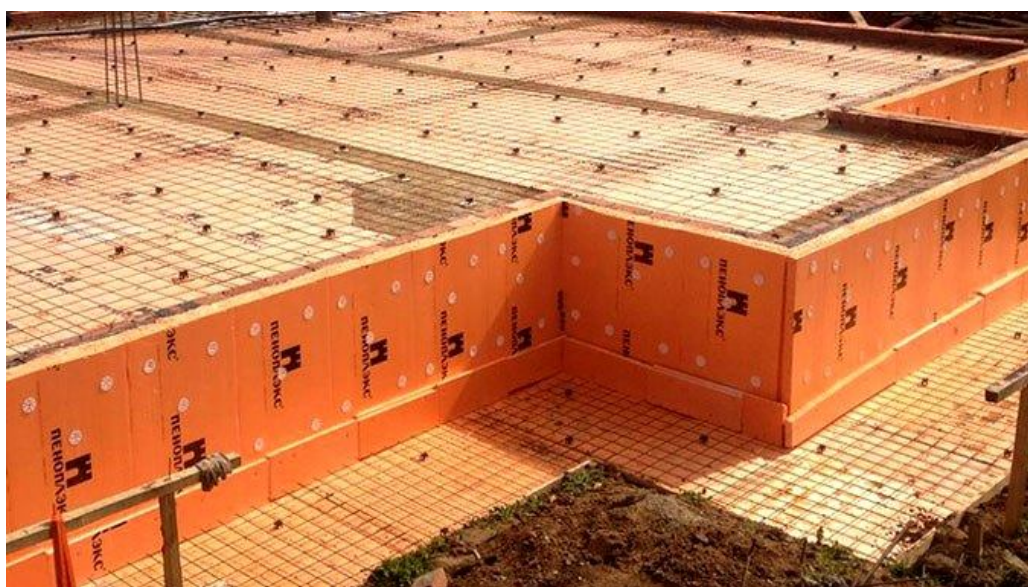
Тотальное утепление плитного фундамента мелкого заложения
